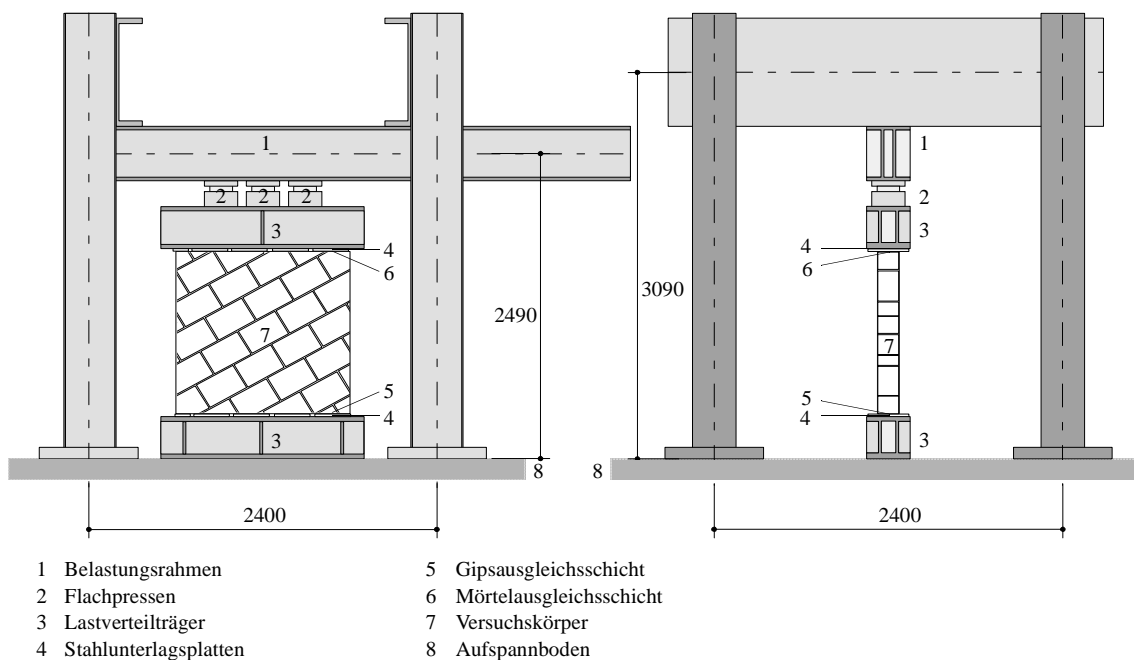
Versuchsanlage für Kleinkörperversuche. Abmessungen in mm.
